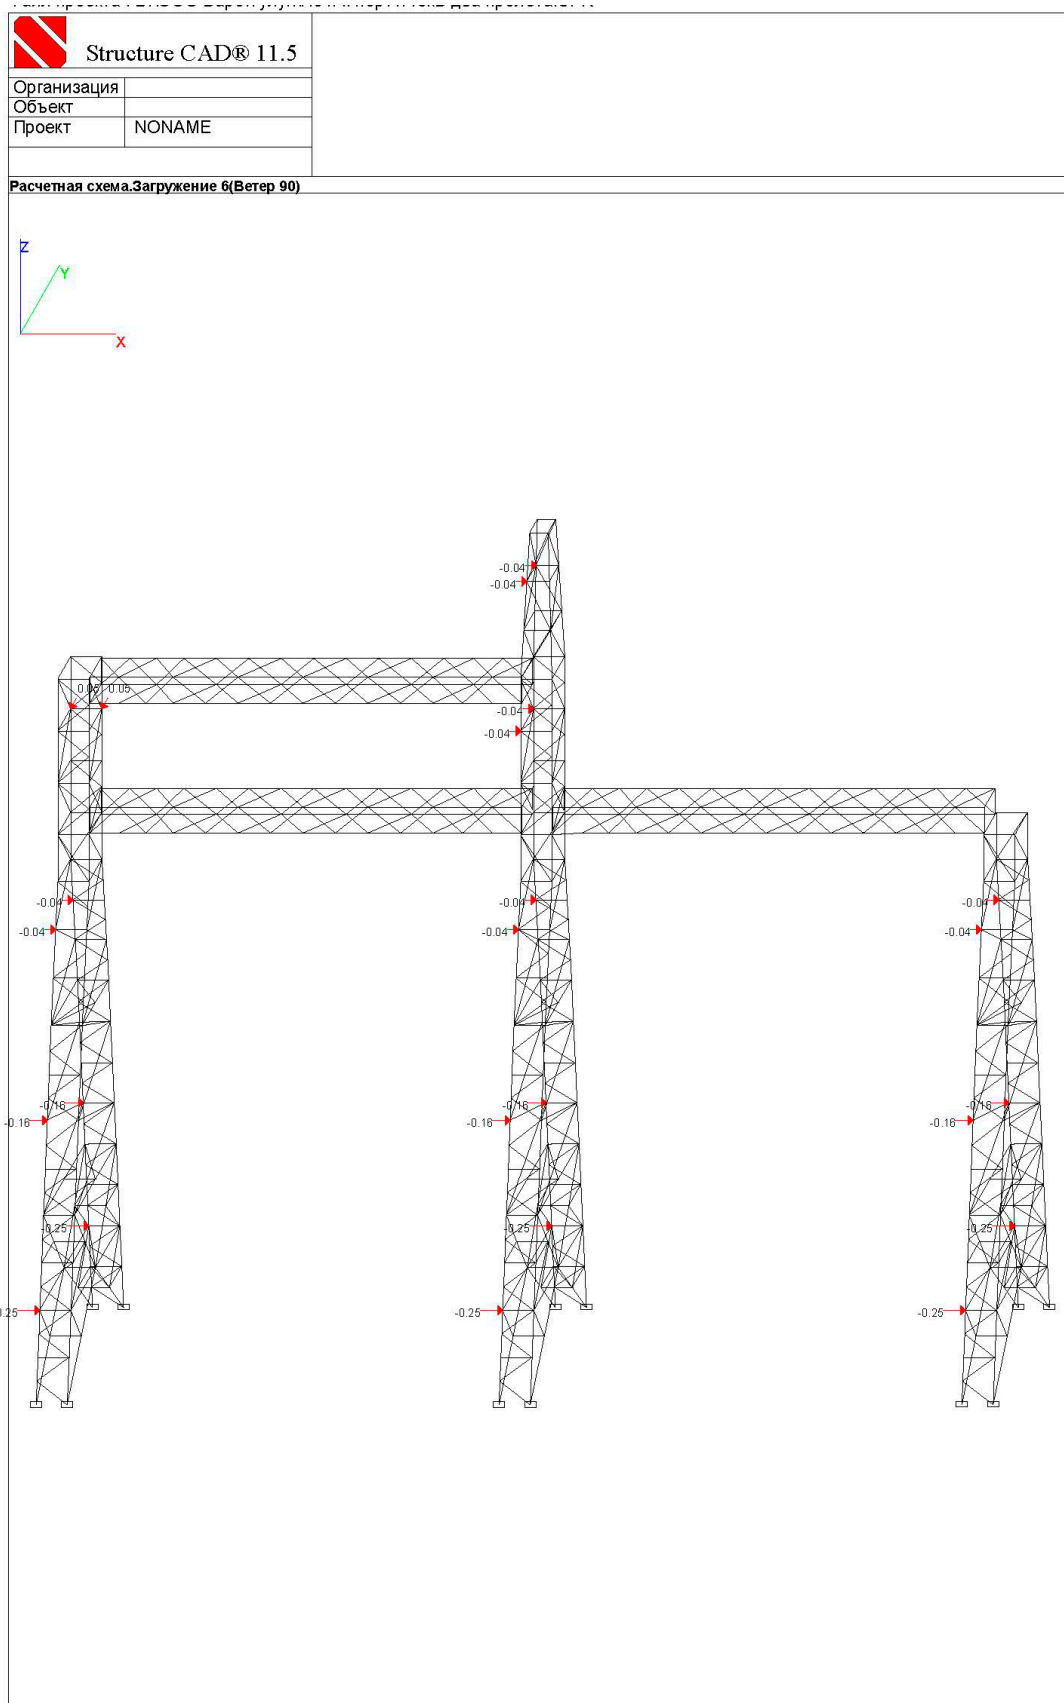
Ветровая нагрузка на провода и опоры перпендикулярно оси ВЛ
